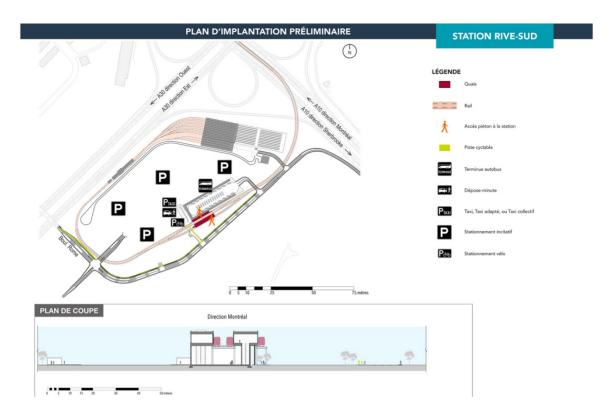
Plan d'implantation de la station Rive-Sud
